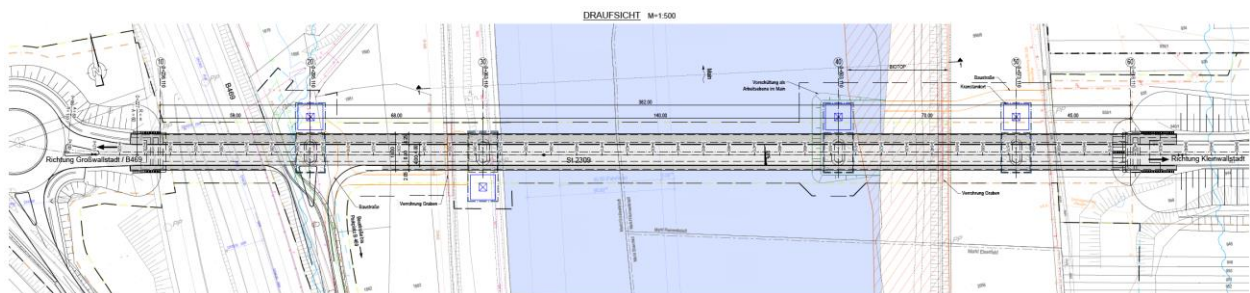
Lageplan Planung Stand März 2025 (SRP)
